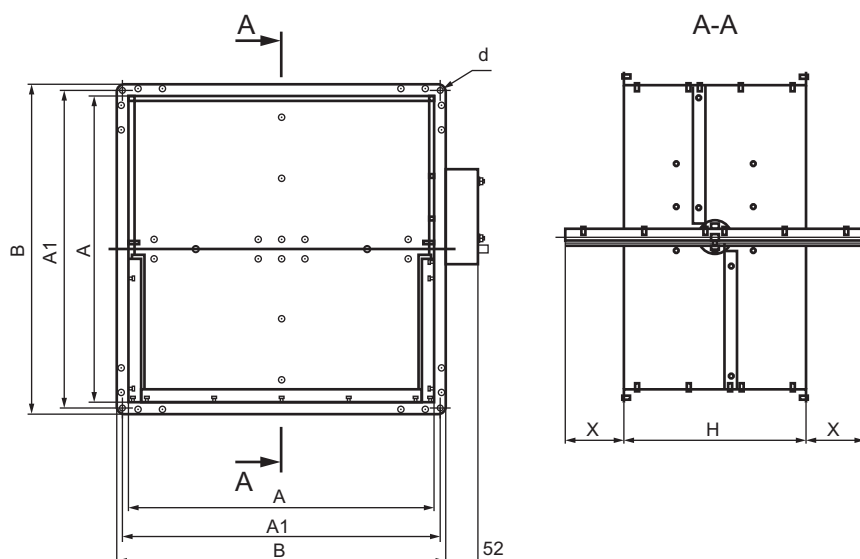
Габаритные и присоединительные размеры клапанов типа КВМ-П квадратного сечения.
